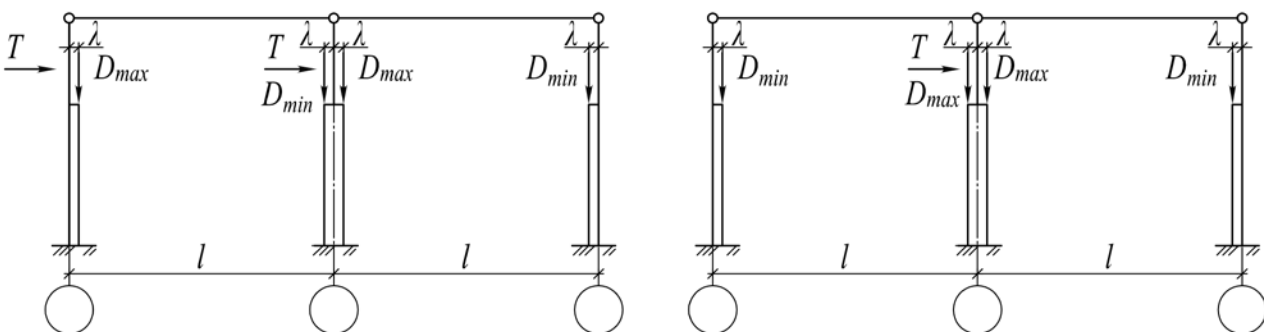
Варианты нагружения поперечной рамы крановой нагрузкой
